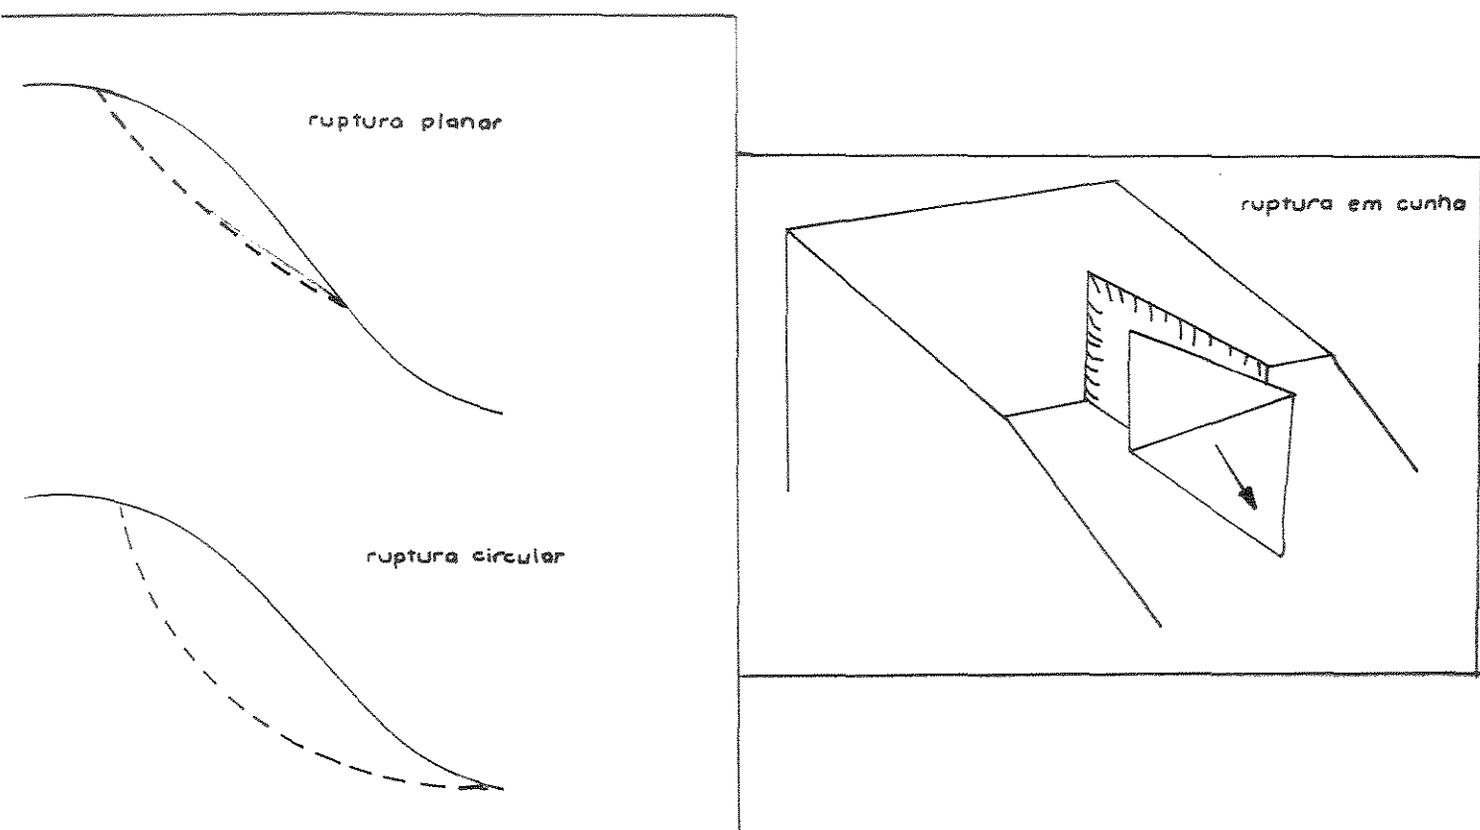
TIPOS DE ESCORREGAMENTO.
